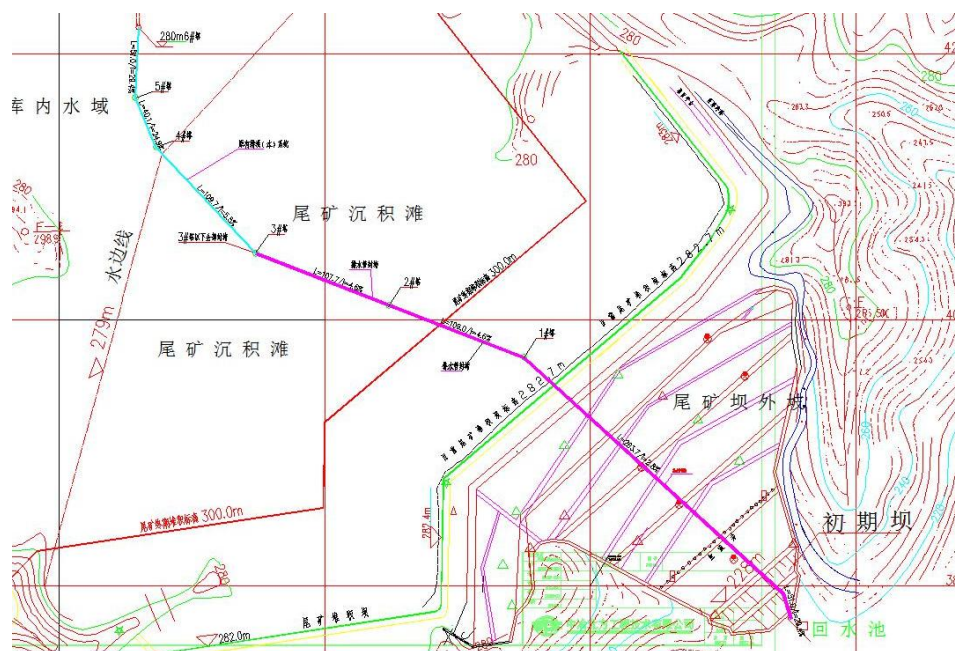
白枣峪尾矿库原设计排洪系统平面图
